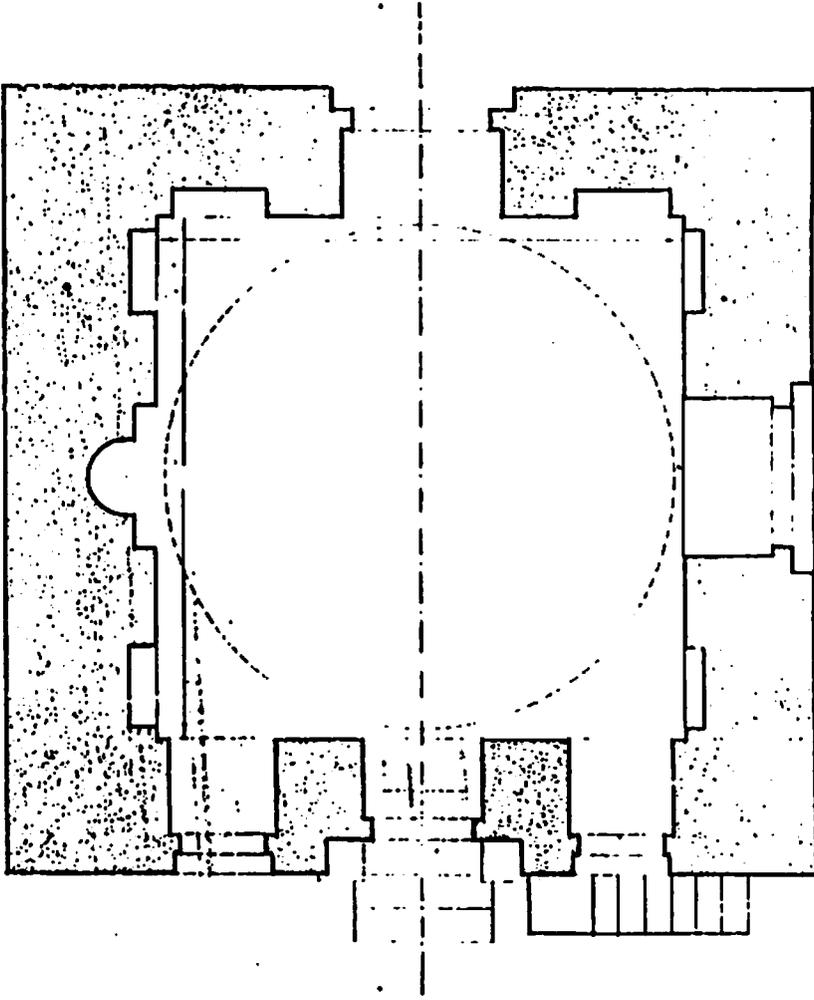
مسقط أفقى لمنشأة أحمد المهندس بالقبانة عن : هيئة الآثار
